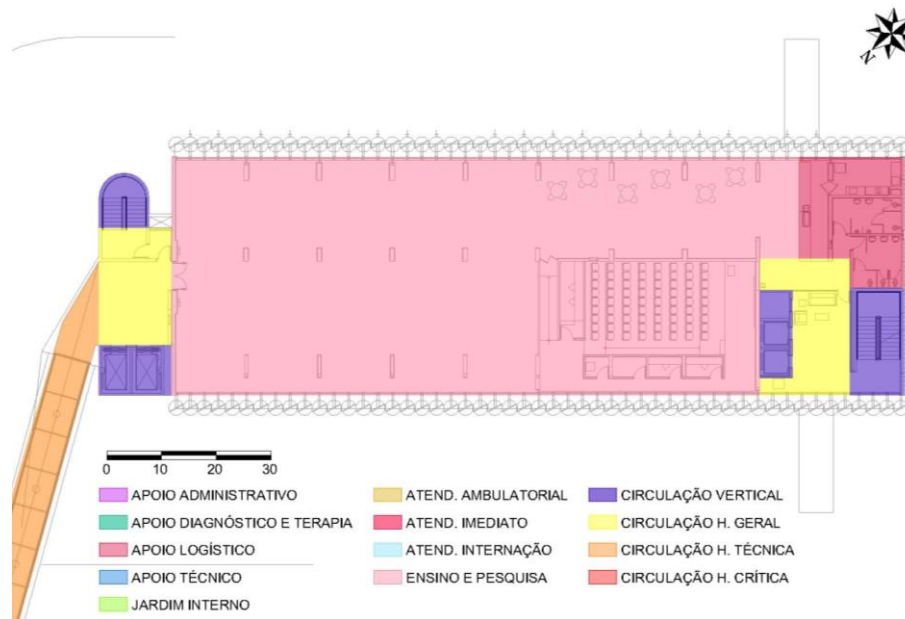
Setorização Edifício Sede, 1º pavimento.
